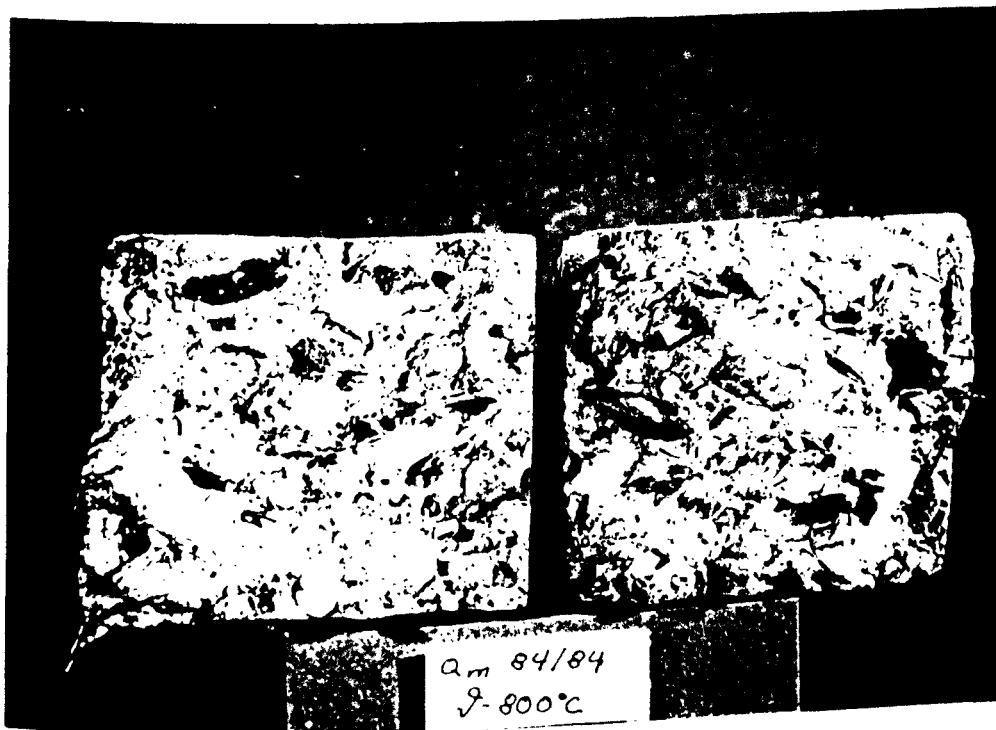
Bruchfläche eines bei 800 °C geprüften, stahlfaserbewehrten Kiesbetonprobekörpers
